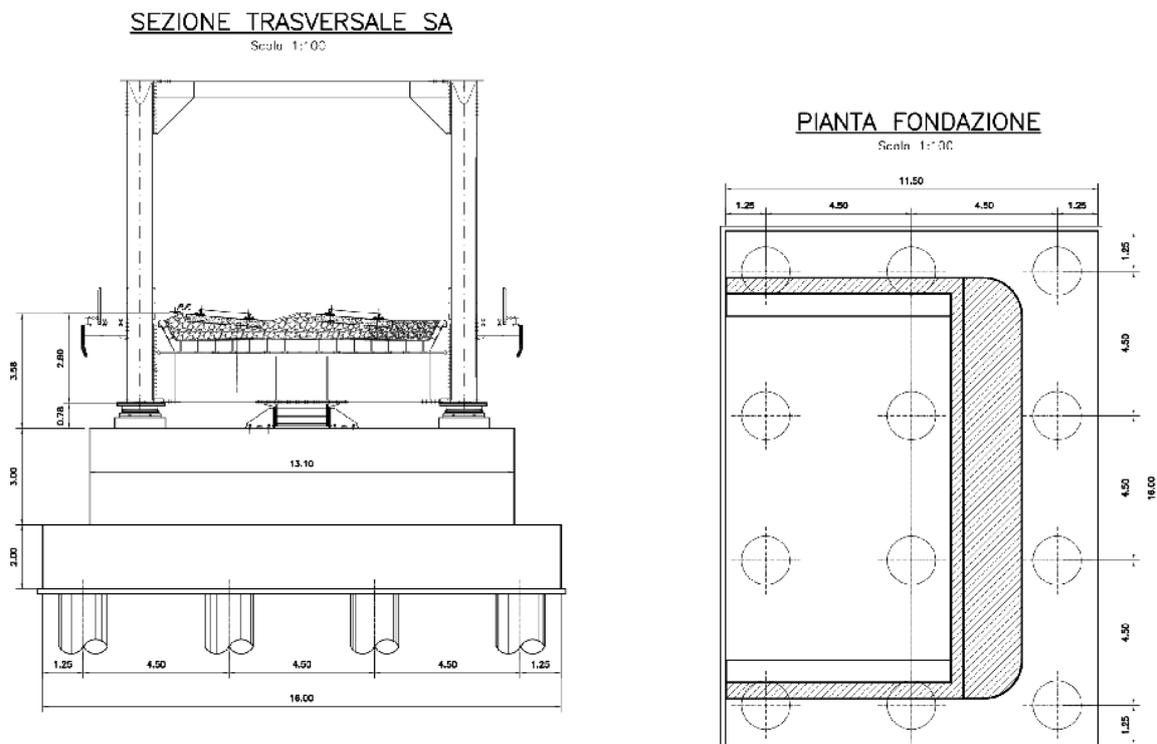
VI22 – Sezione su spalla A e pianta plinto di fondazione
